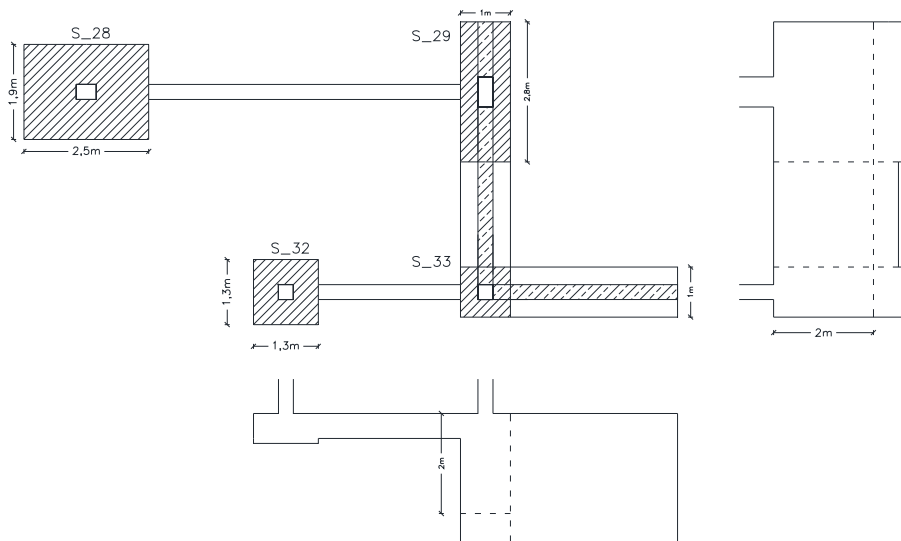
Esquema do sistema de fundações dos pilares PL\_29 e PL\_33
